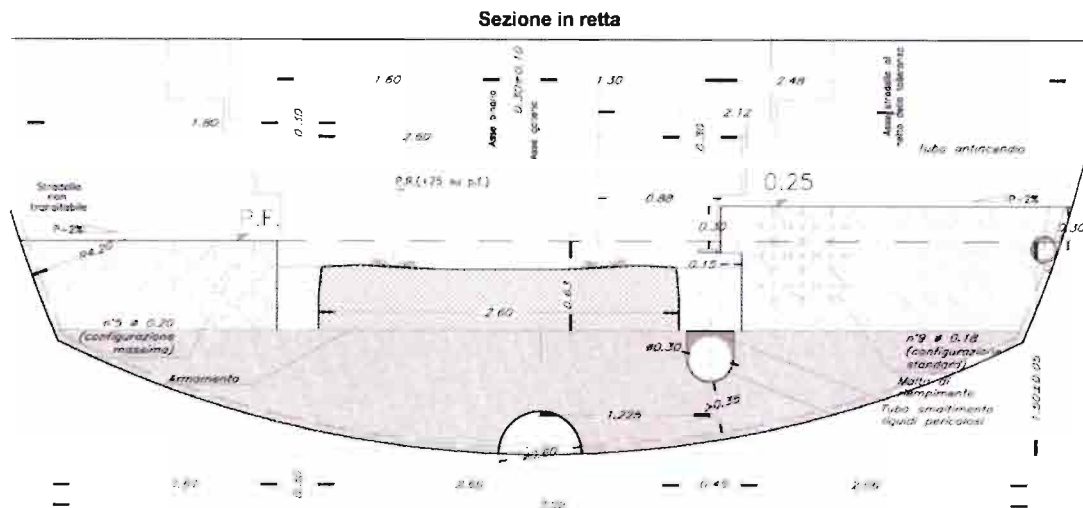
Piano di regolamento tratto in scavo tradizionale
